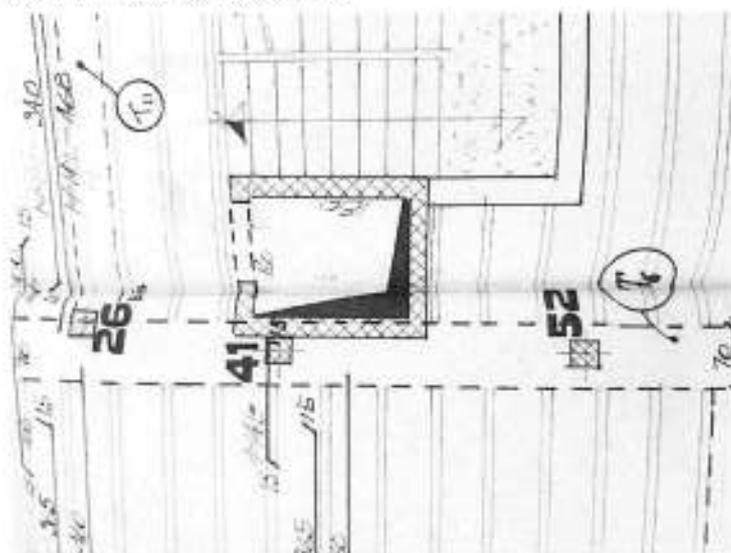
TAV. 2 – pianta (particolare intorno al vano ascensore)
